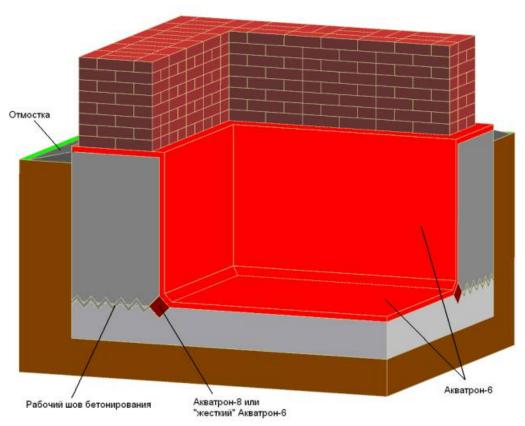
Устройство гидроизоляции бетонного фундамента и стены.
